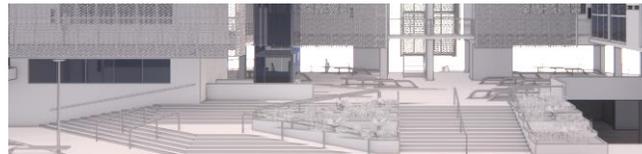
Vista 3d escalera plaza elevada. Autoría propia.
